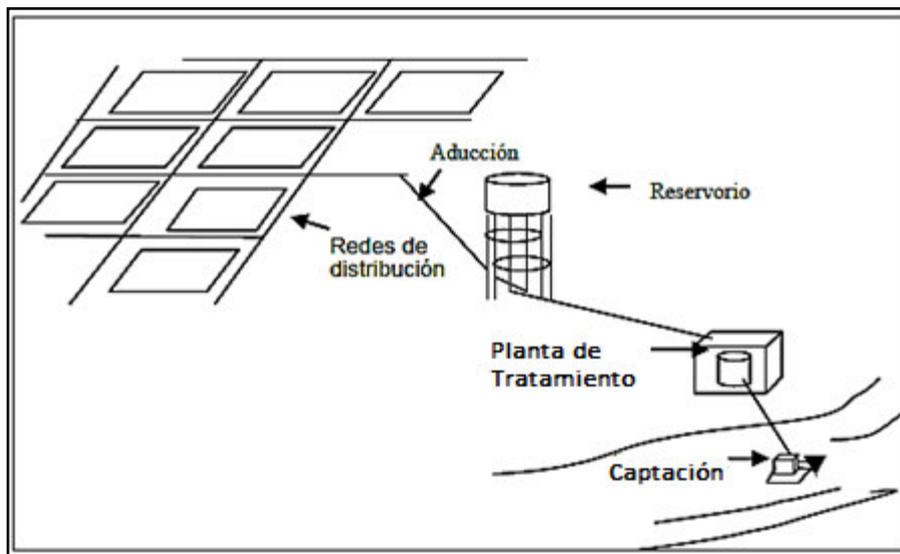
Conducción por Bombeo con Planta de Tratamiento
